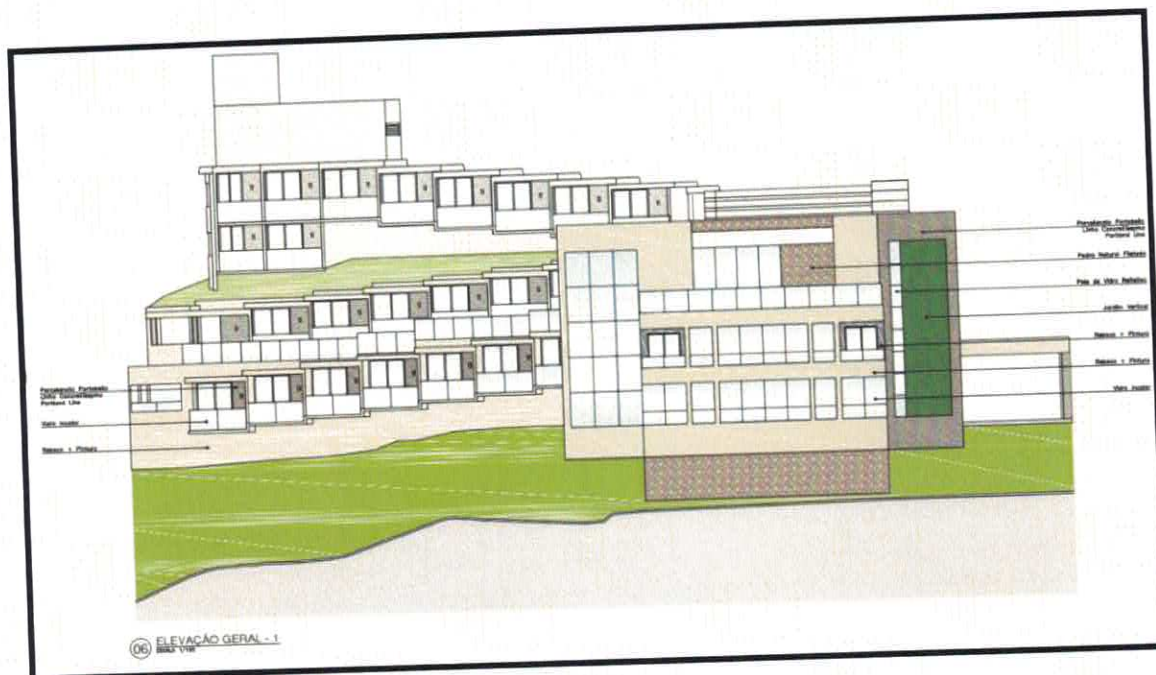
Ilustração do empreendimento (fonte: Projeto Arquitetônico)
